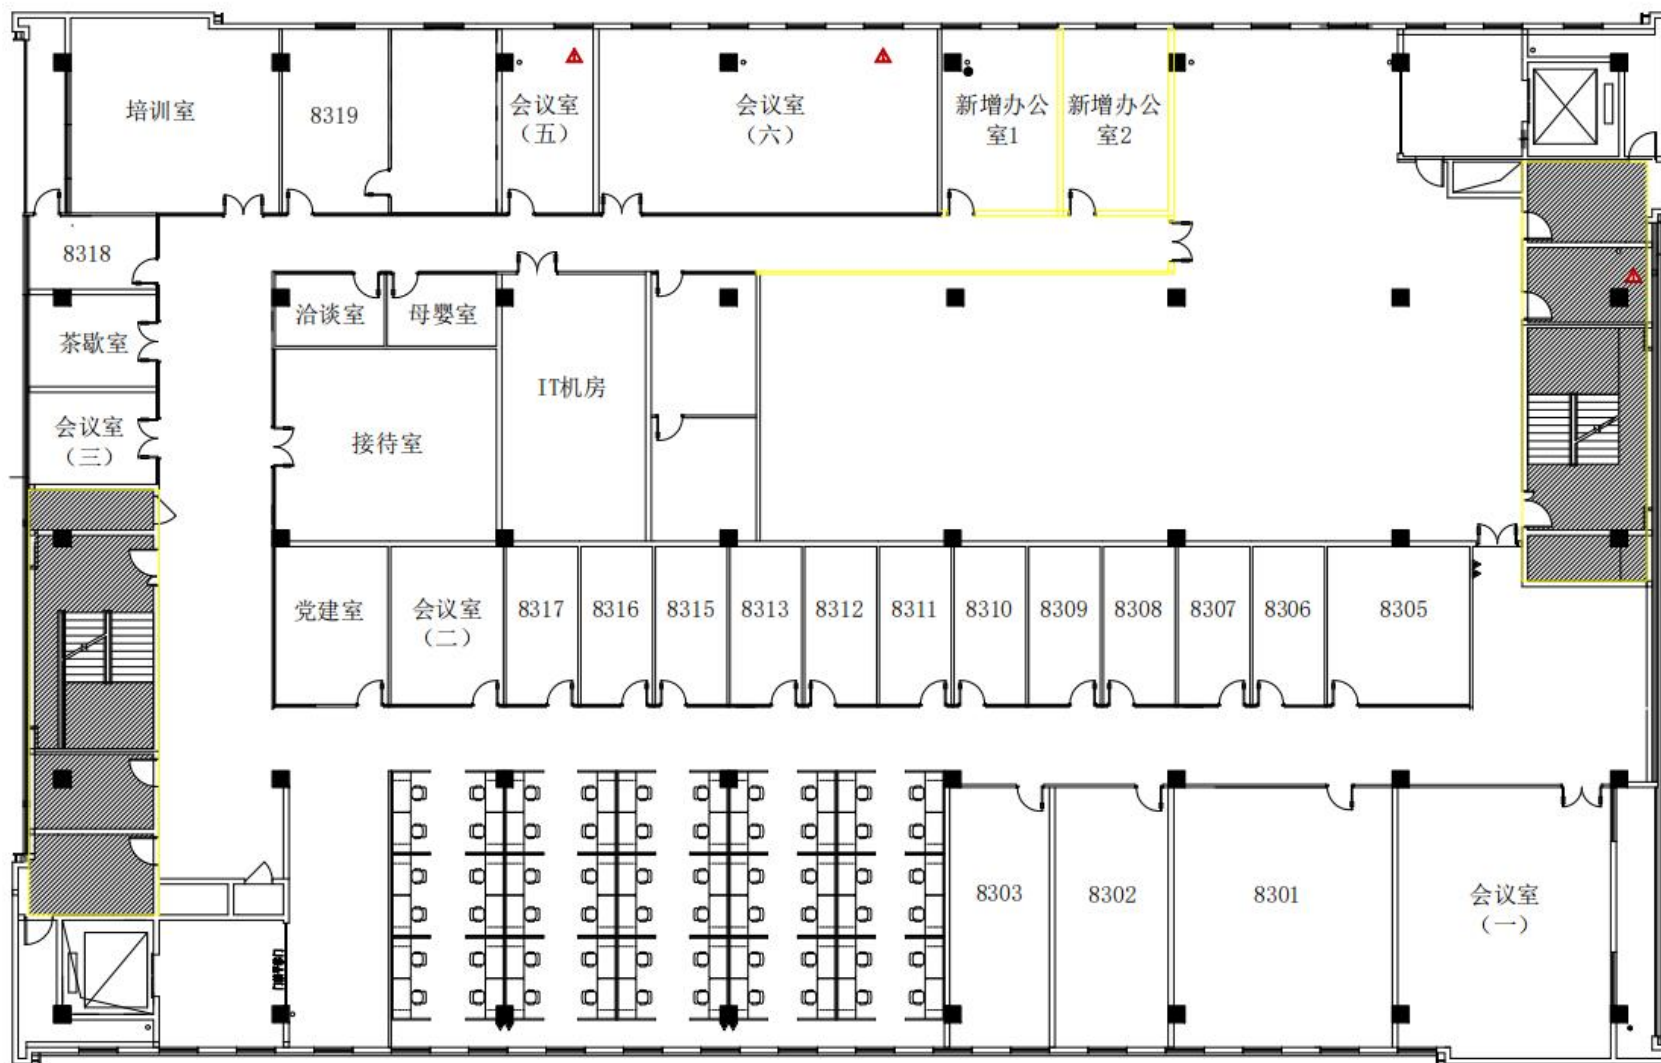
6#厂房三层平面布置图（与环评中一致，均为办公室）
